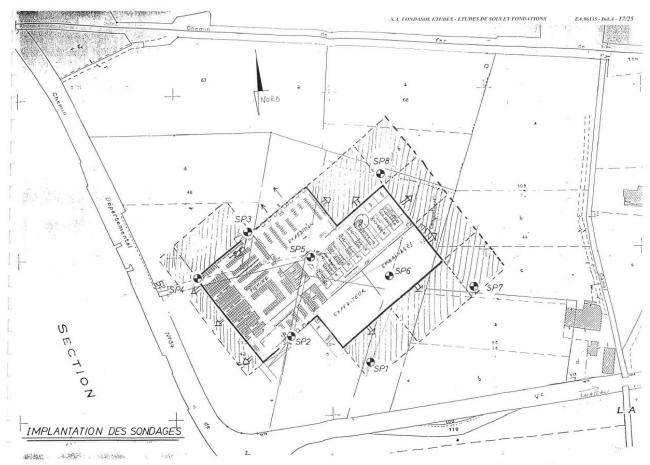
Plan d'implantation des sondages (source : FONDASOL, 07/08/1996)
